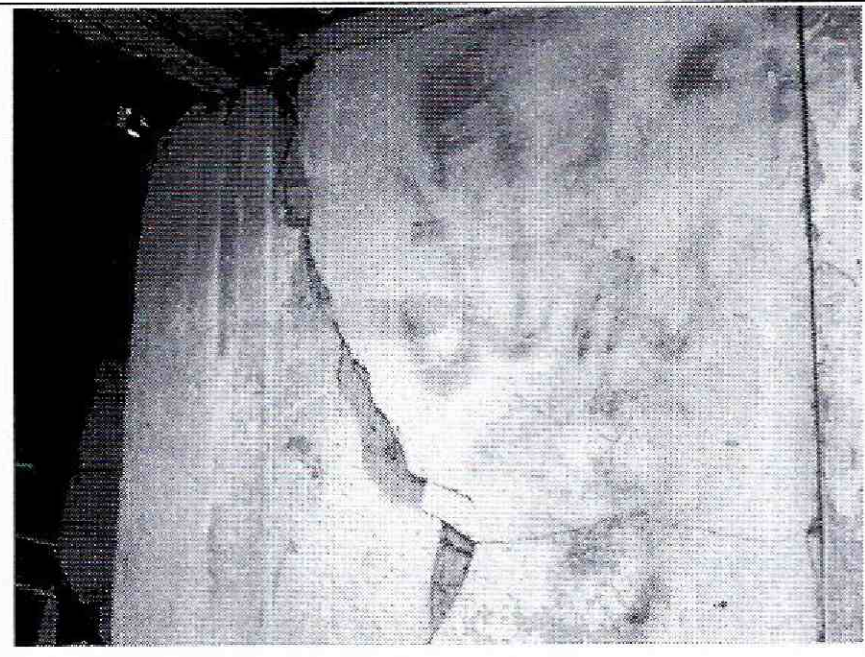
Agrietamiento en muro del sector del patio.
